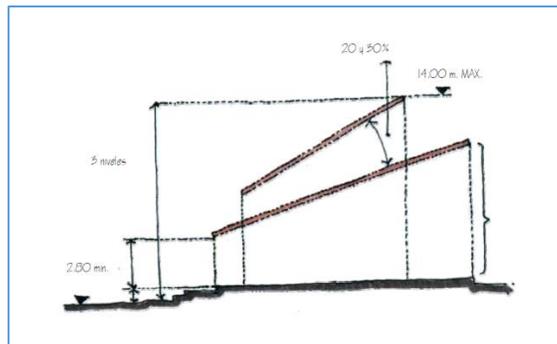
Cubiertas y pendientes de la casa Tipo proyecto
